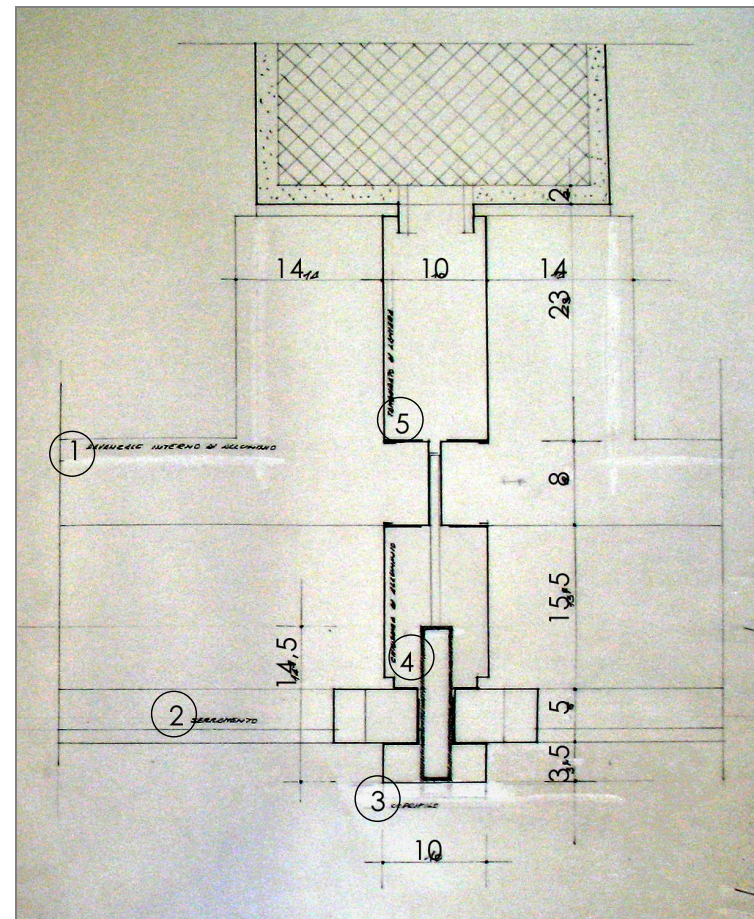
sezione orizzontale nodo serramento-montante-pilastro (fonte CSAC – stralcio tav. 40, archivio n. 181-3, rielaborazione f.m.)
